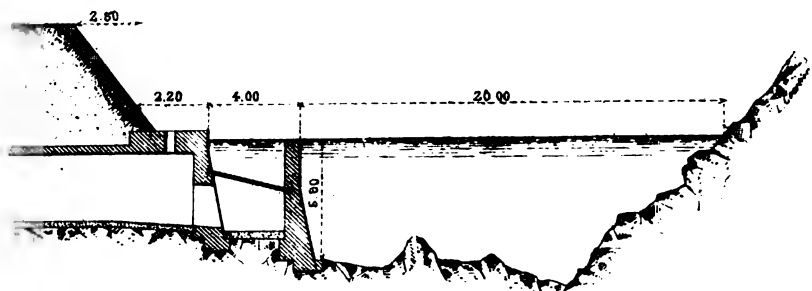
Section du barrage de l'Arly, à Ugine (Savoie).
